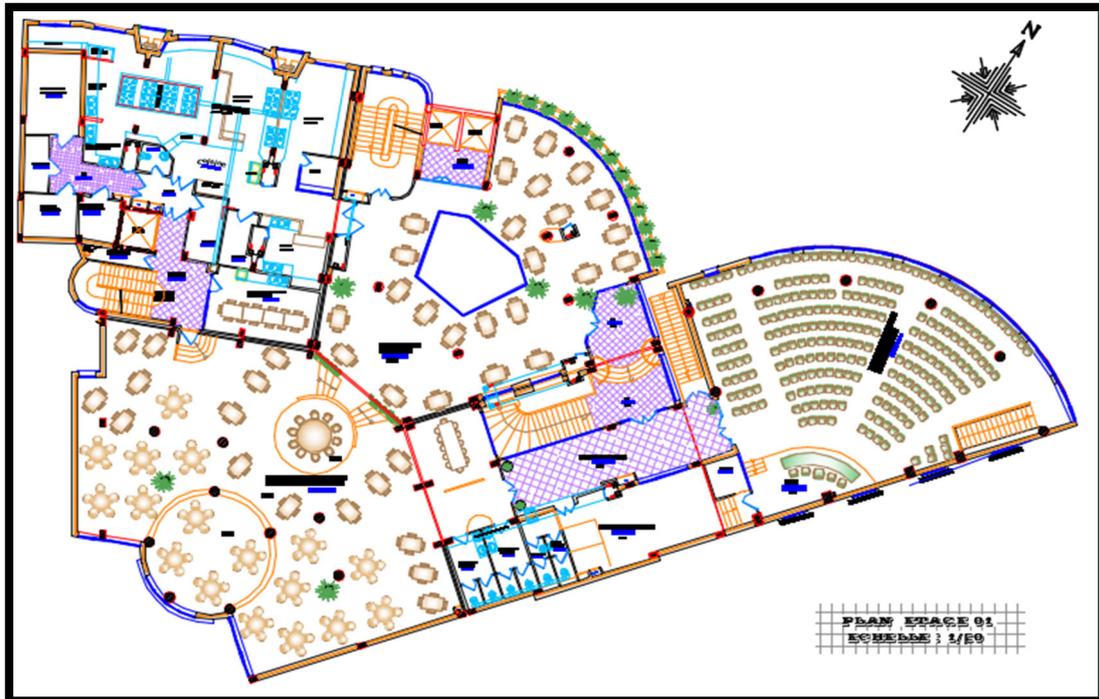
Plan du 1<sup>er</sup> étage du cas d'étude.
